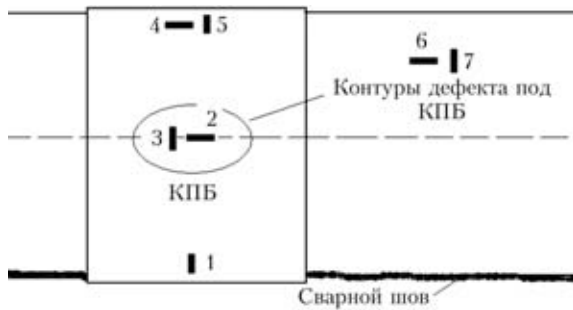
Схема размещения датчиков (тензорезисторов) на образцах-стендах Ду 720 и Ду 530
